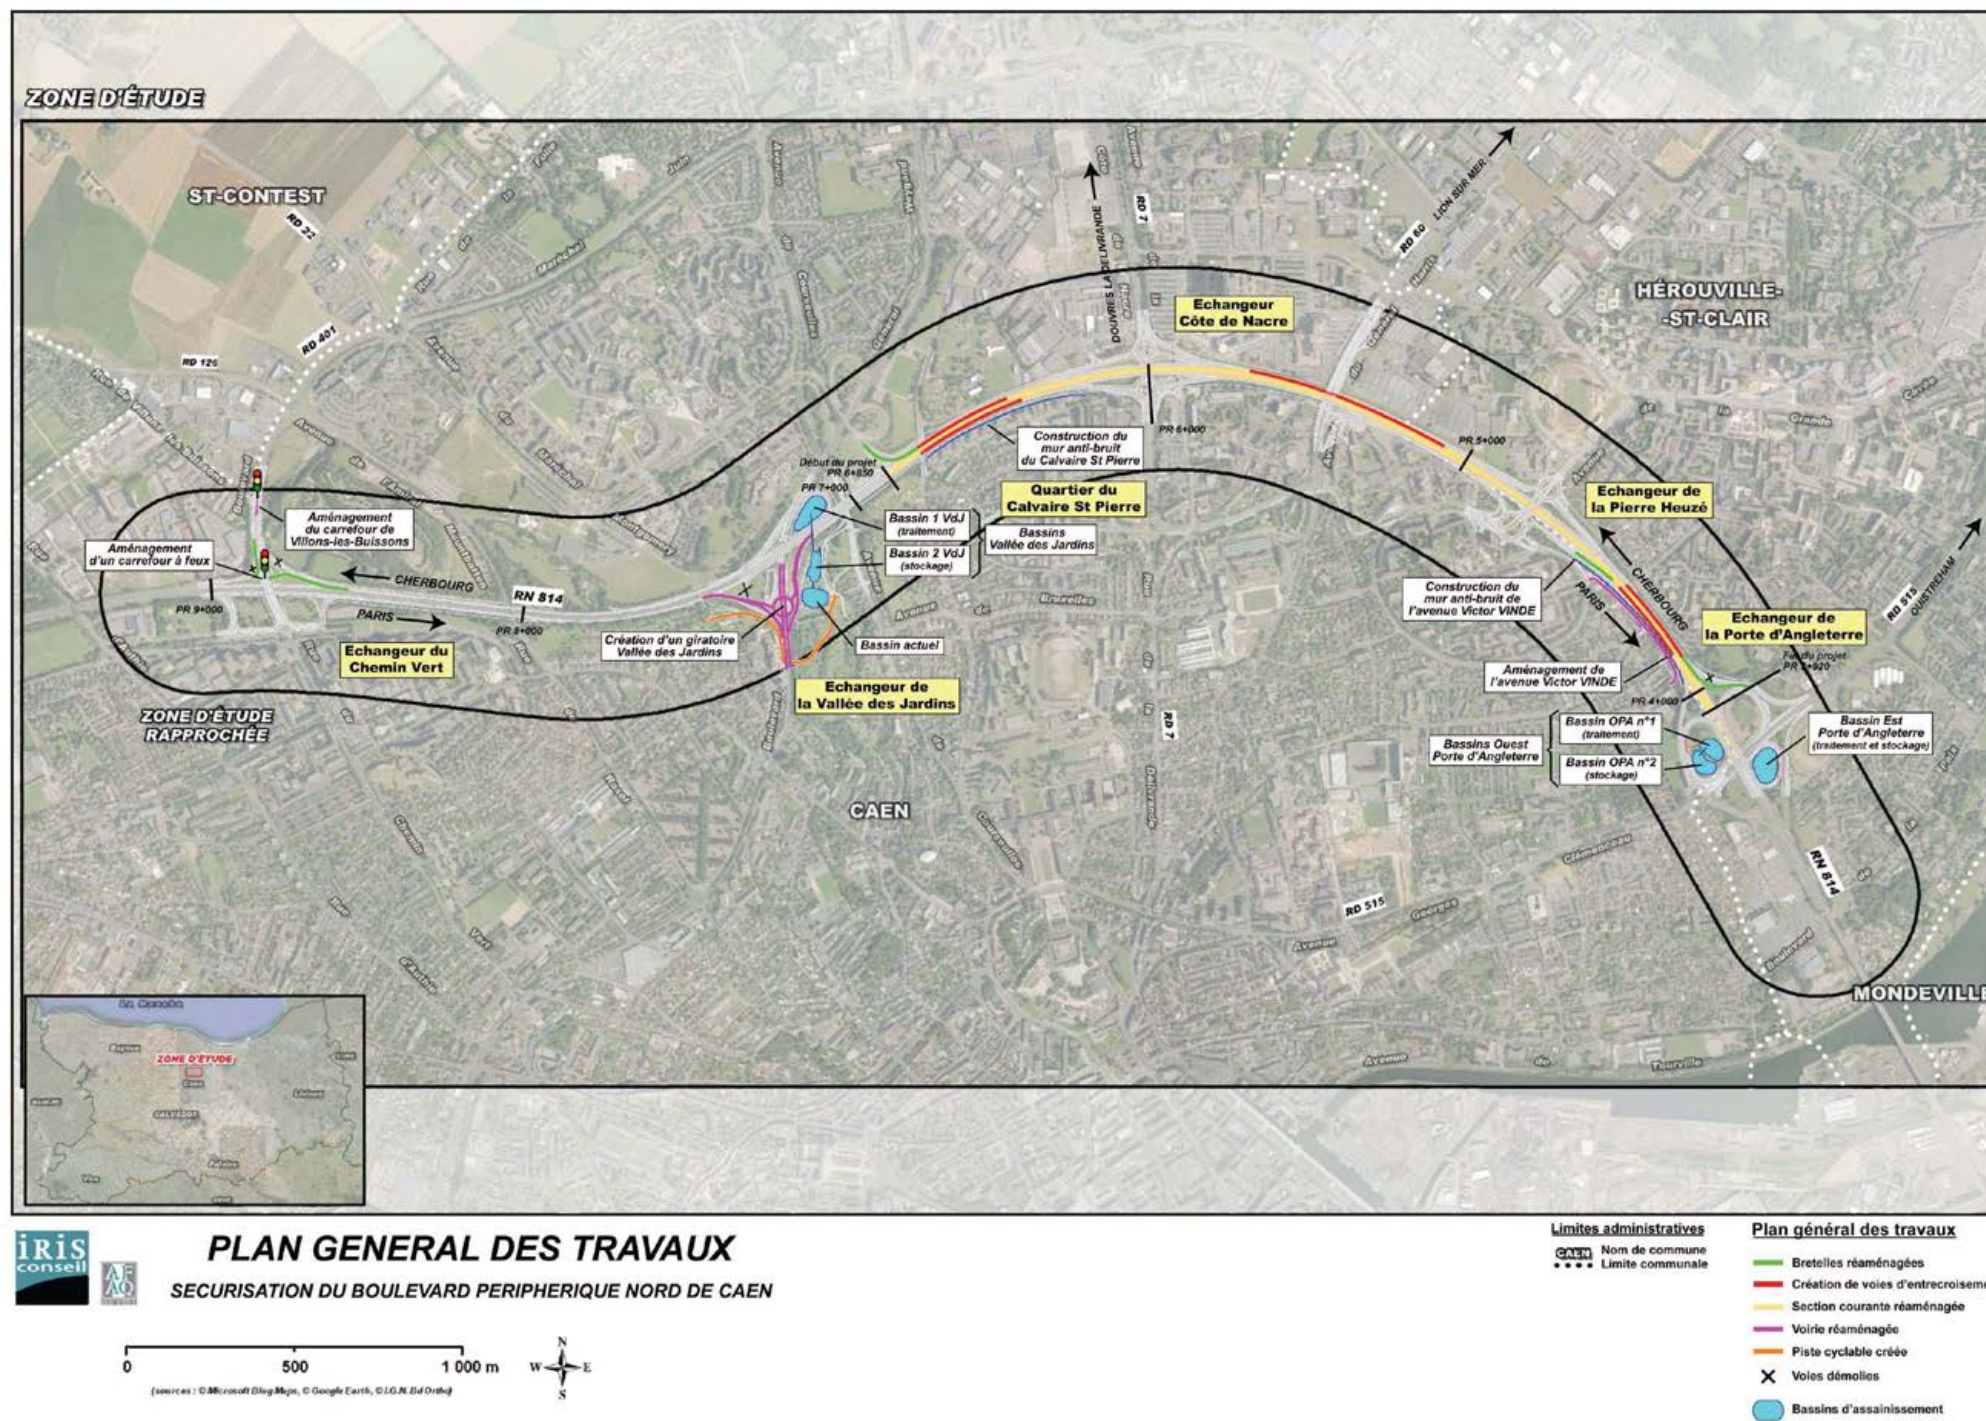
plan général des travaux (extrait de l'étude d'impact)
